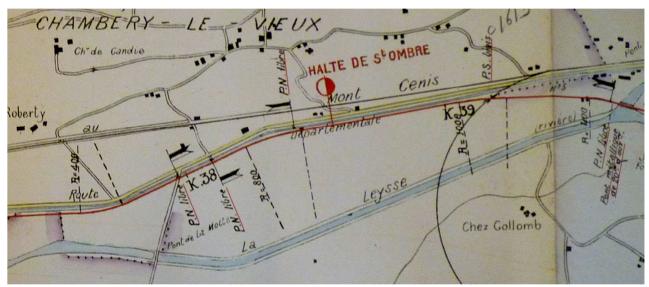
Digue 4.3 - Digues de la Leysse après redressement, 1913 (AD 73 - 65SPC 2)
